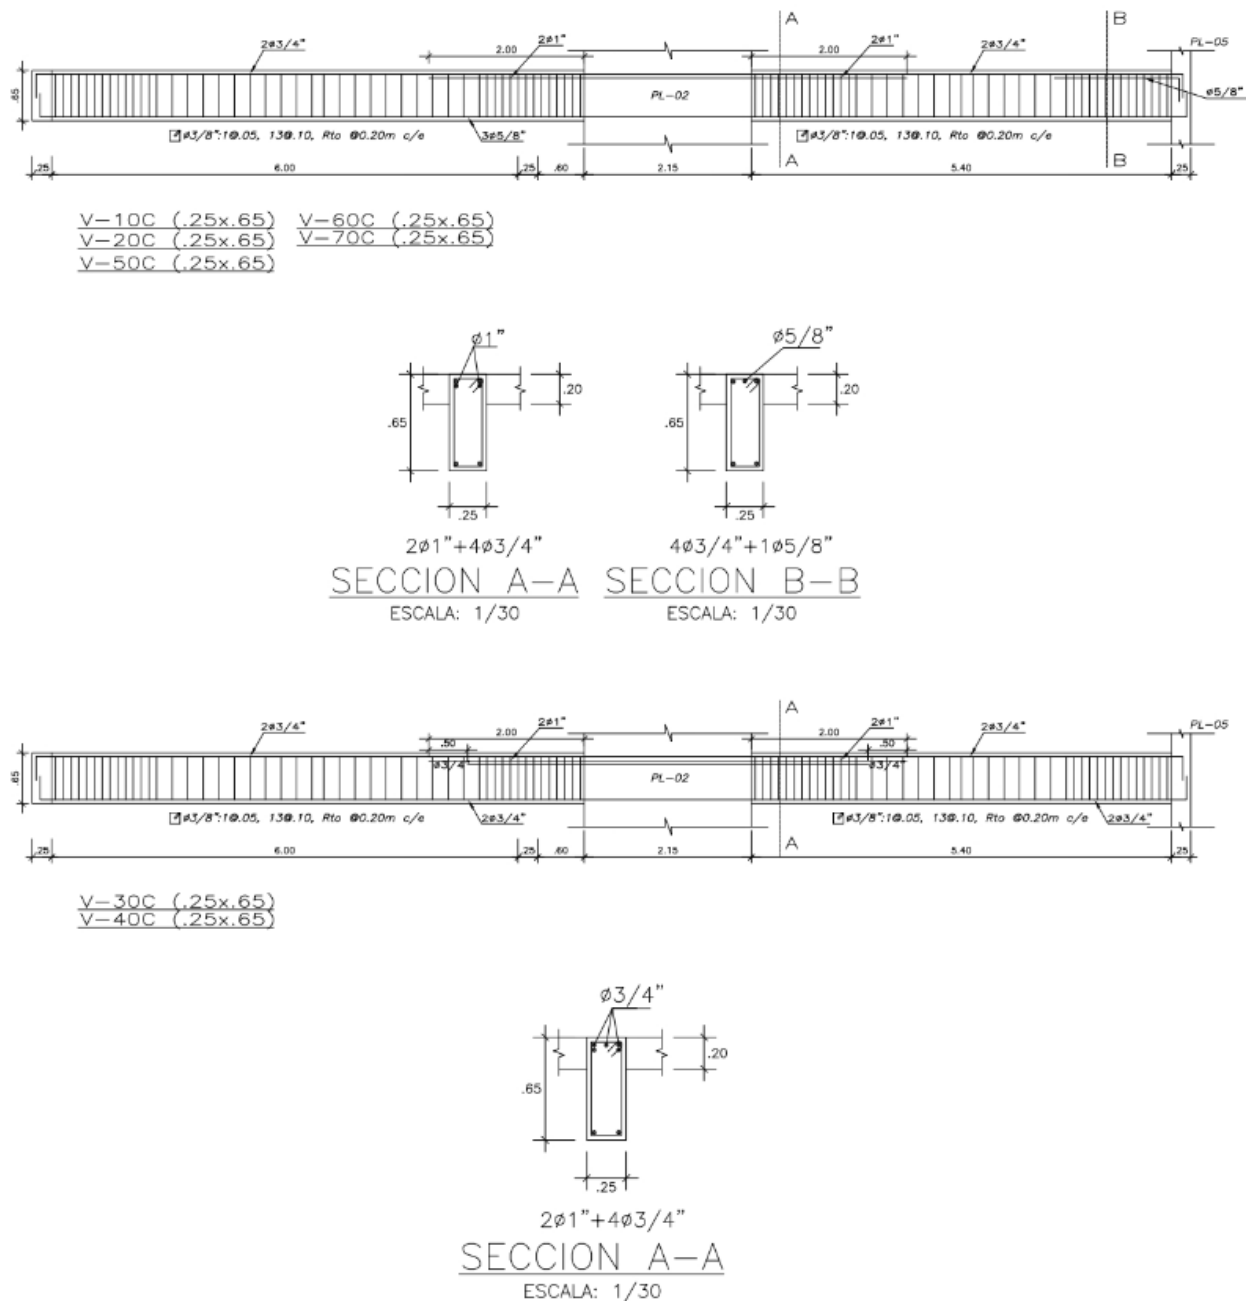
Armado y secciones de las vigas V-10C a la V-70C
